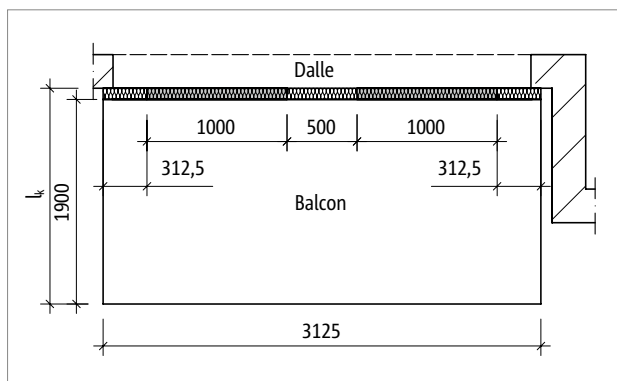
Schöck Isokorb® T Type K-E, K-T : Système statique, plan de base
